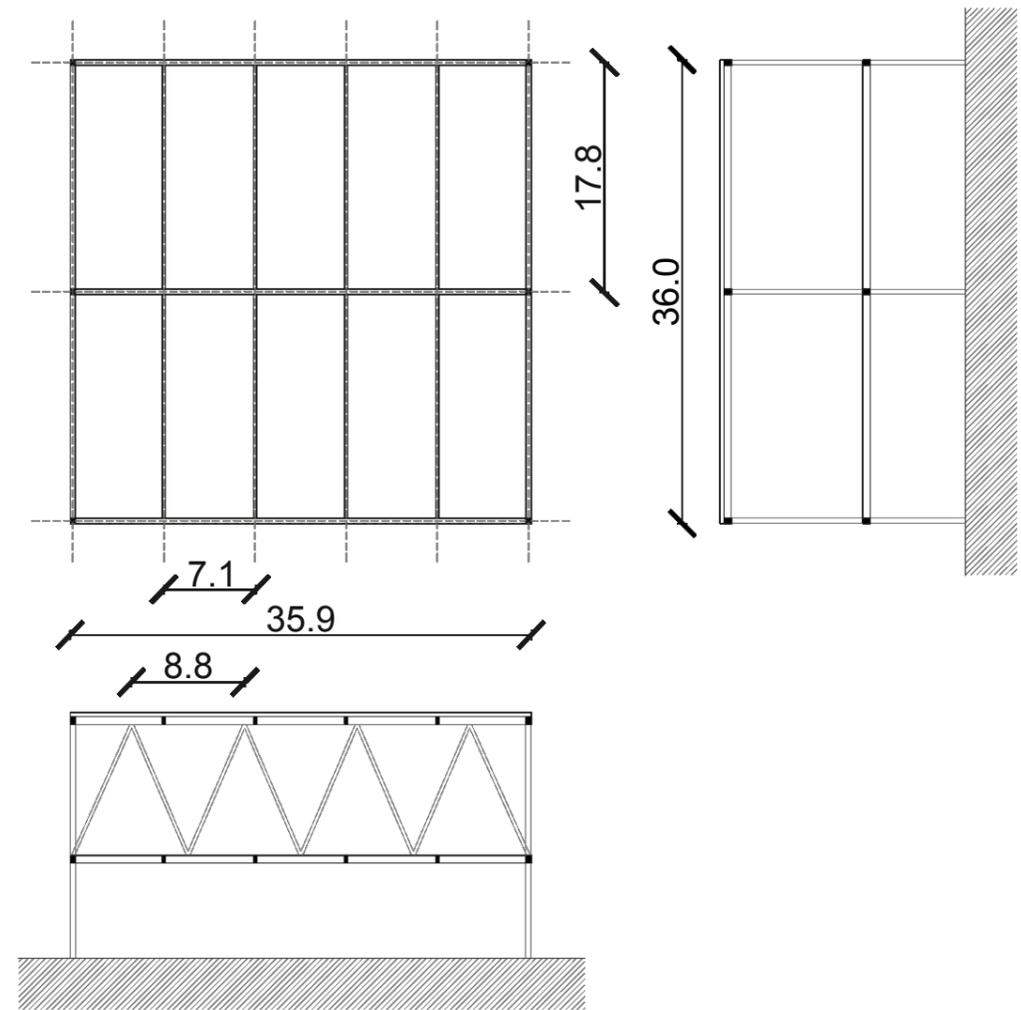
Konstruktionsprinzip - Tennishalle
